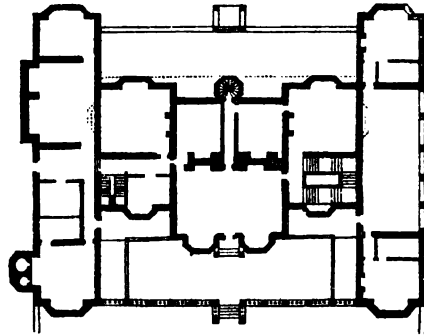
Grundriß des Holland House in Kensington. Nach H. Blomfield, „A history of Renaissance Architecture in England“. London 1897.
